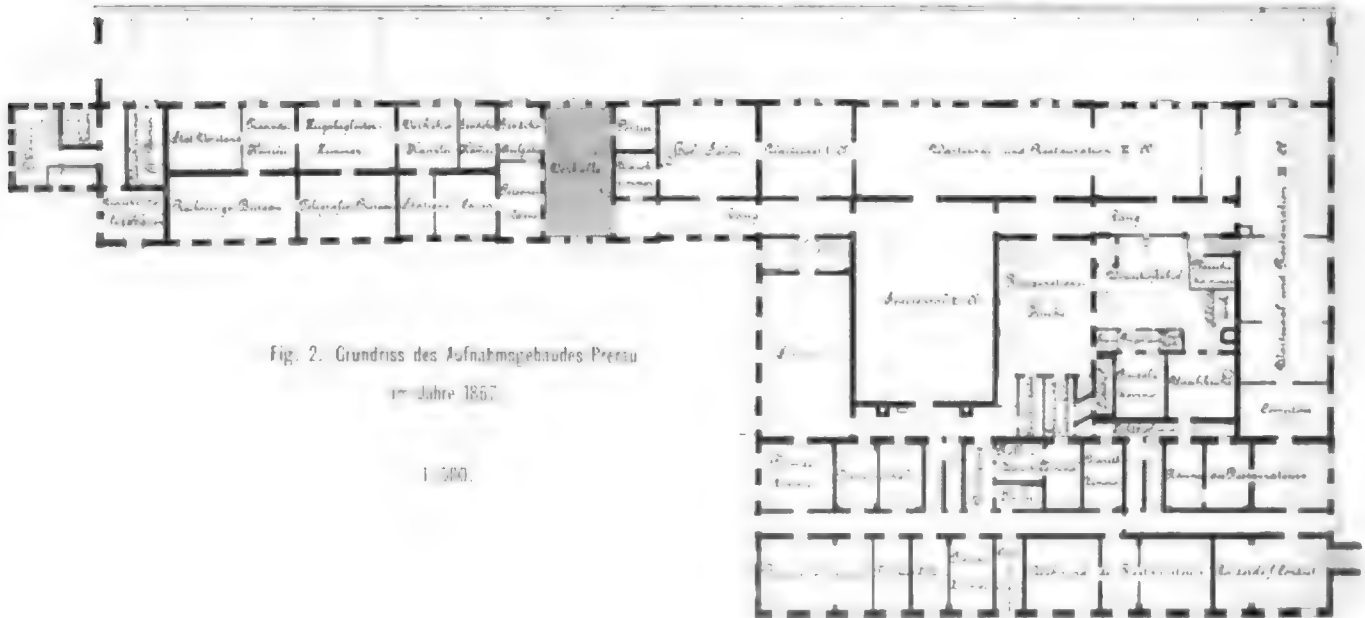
Grundriss des Aufnahmegebäudes Prazau
